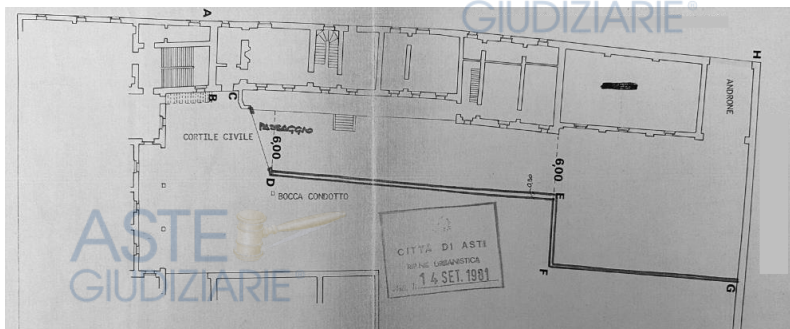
Evidenziazione del muretto che doveva essere realizzato da progetto Conc. 303/1981
